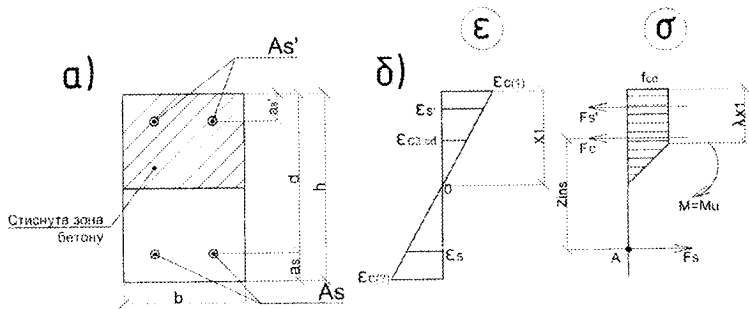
Поперечний переріз (а) та напружено-деформований стан (б) нормального перерізу балки з подвійним армуванням
